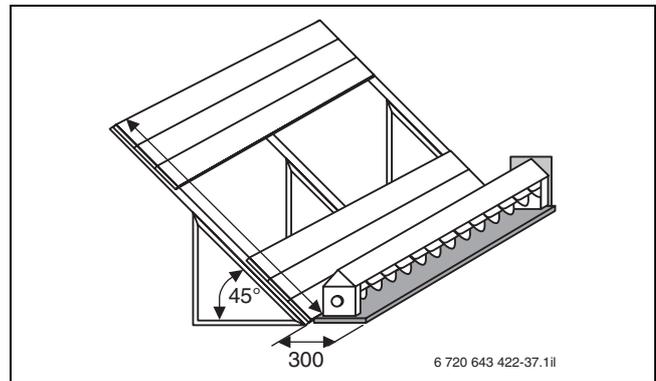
Schnecke auf einem Holzbrett am Boden montieren (Maße in mm)
